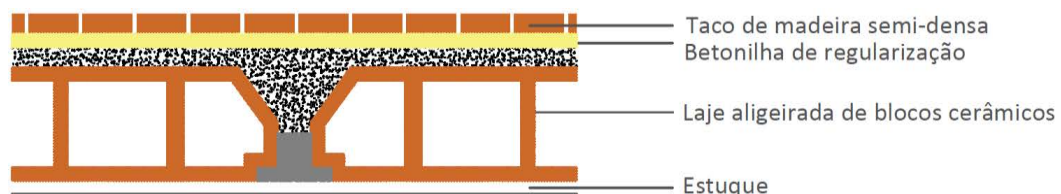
Solução construtiva tipo de pavimento sobre comércio/serviços – Pós intervenção
